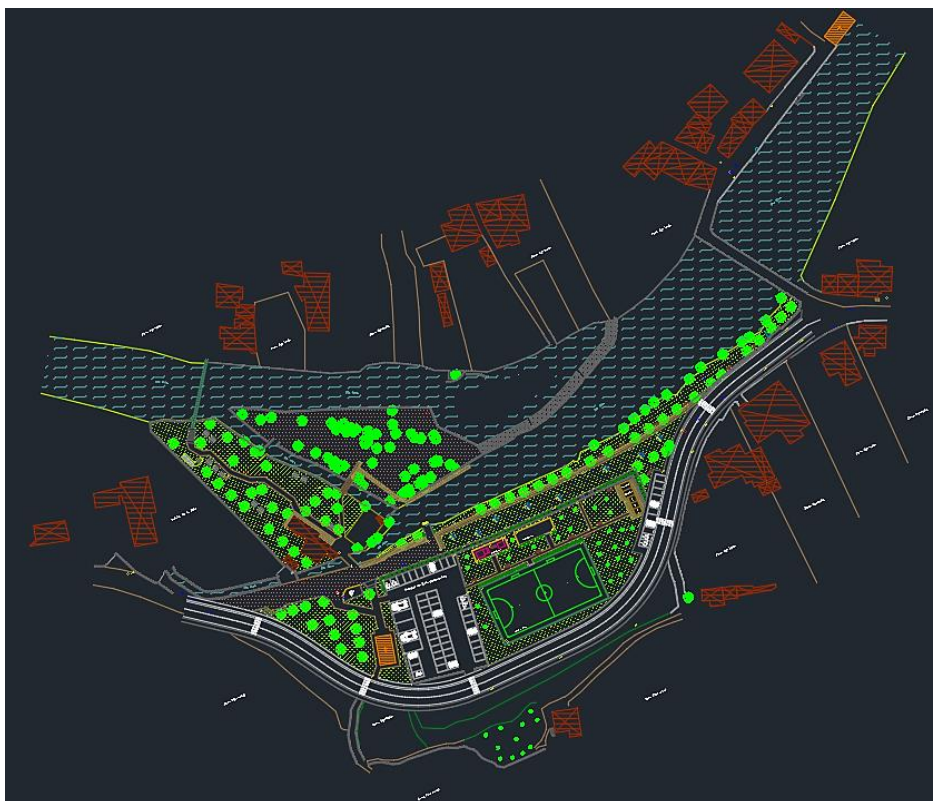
Planta topográfica final com as soluções propostas (Fonte: AutoCad Civil 3D)
